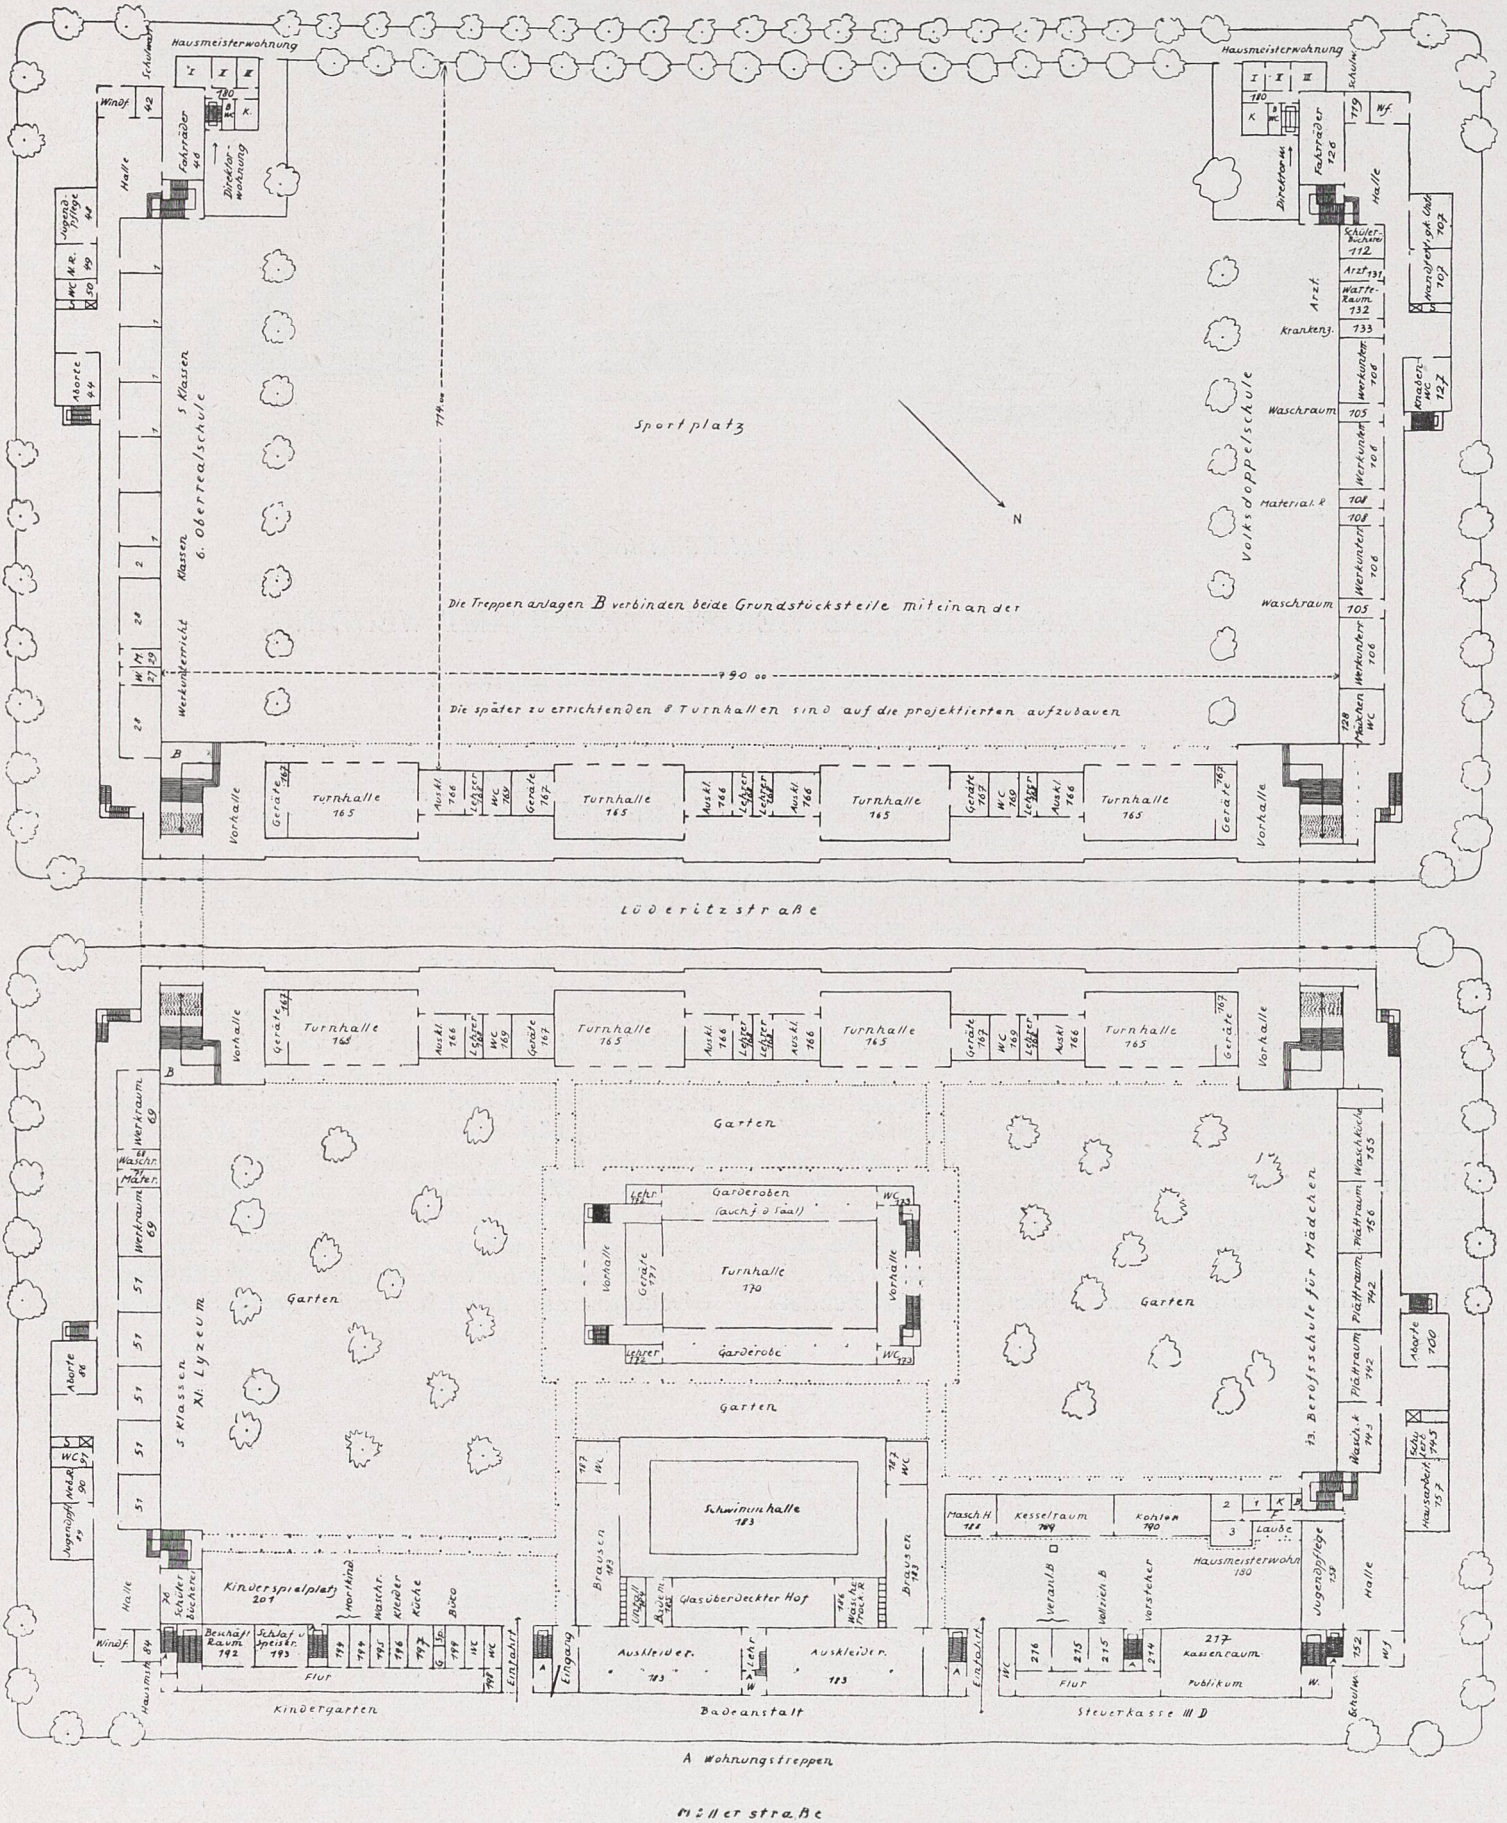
Grundriß vom Erdgeschoß. •M. 1:1200.
